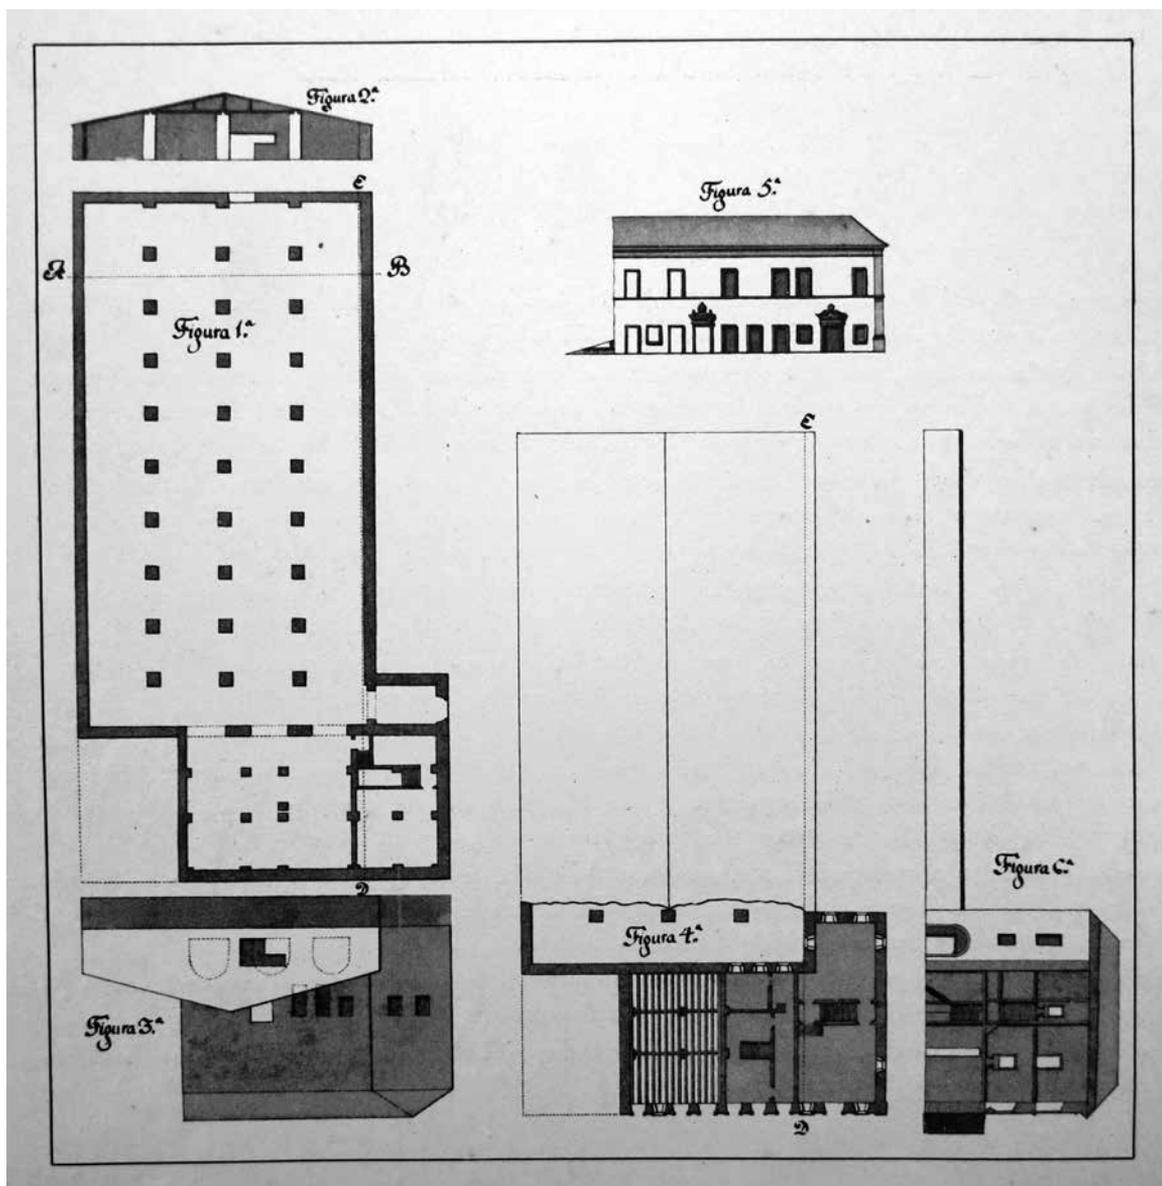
PLANTA TRAPICHE BARNABÉ 1757
